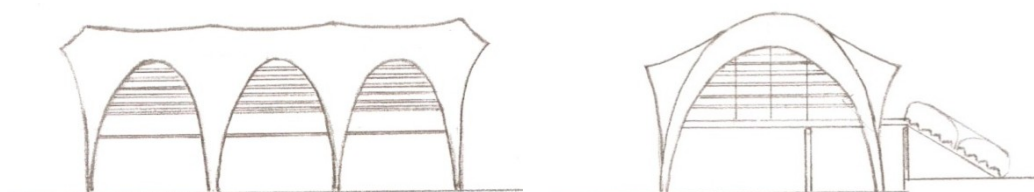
Croquis para ampliação proposta no campus da PUC-Rio, fachadas nordeste e noroeste, elaborado por Teixeira Filho (outubro, 2011).
